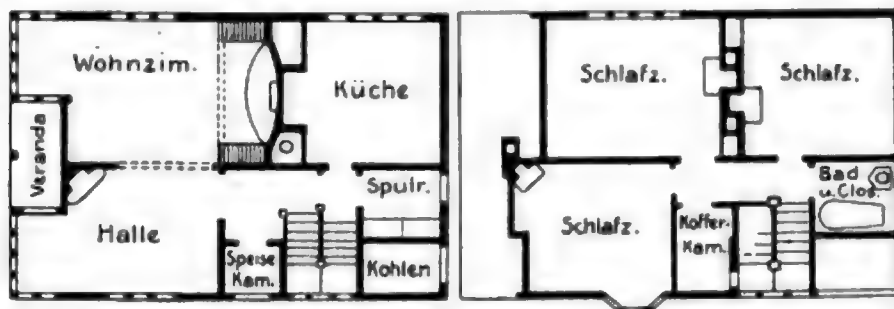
u. 6. GRUNDRISS DES ENGLISCHEN LANDHAUSENTWURFS, links Untergeschoß, rechts Obergeschoß.
